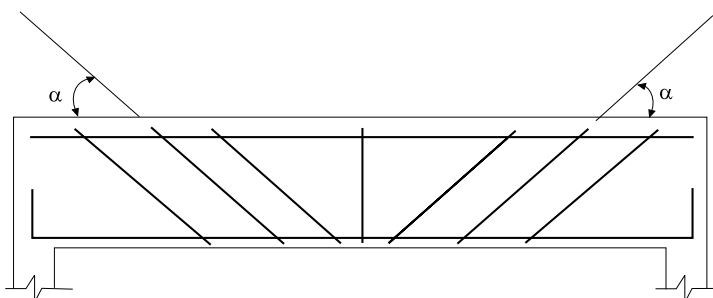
Representação esquemática da disposição dos estribos da viga.
